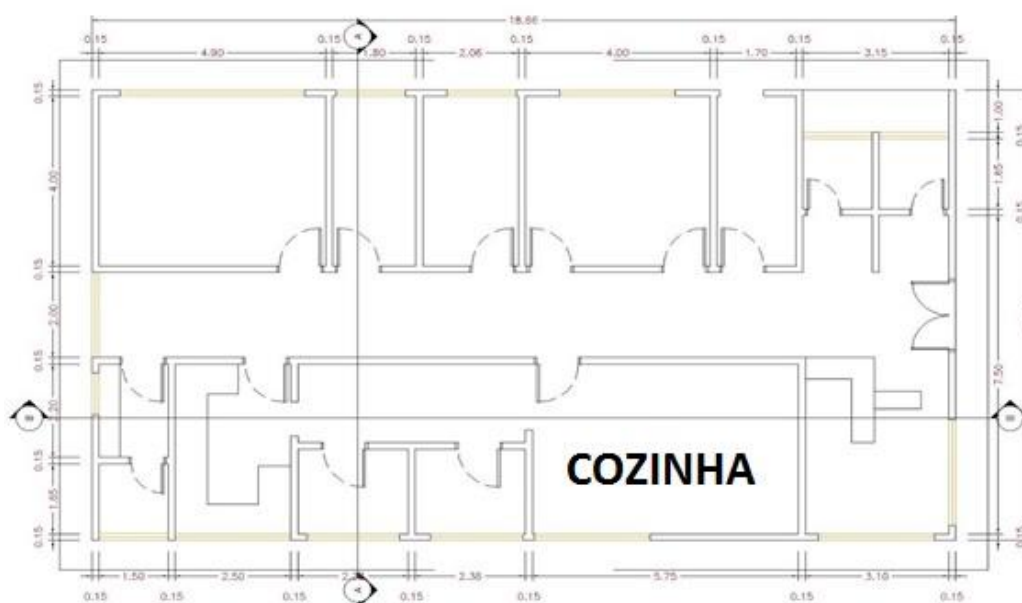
Planta Baixa do Bloco onde localiza-se a cozinha.
